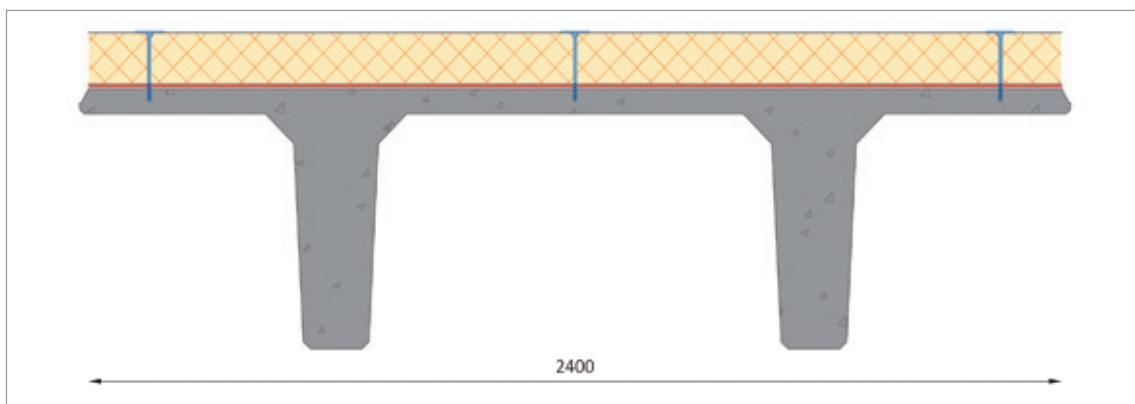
Exemple d'une poutre TT simple avec fixation dans le support
